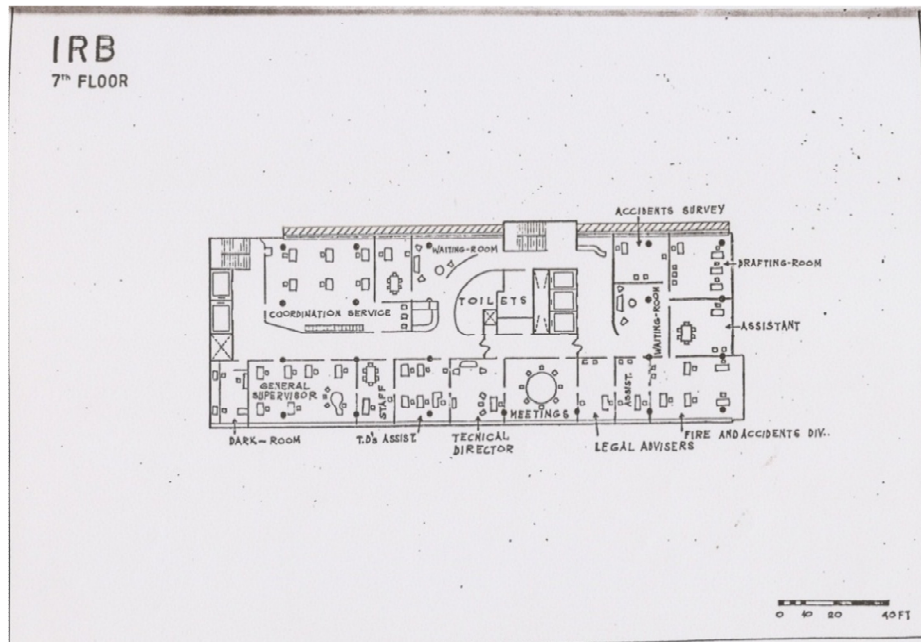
M – Planta baixa sétimo pavimento (andares corridos)
